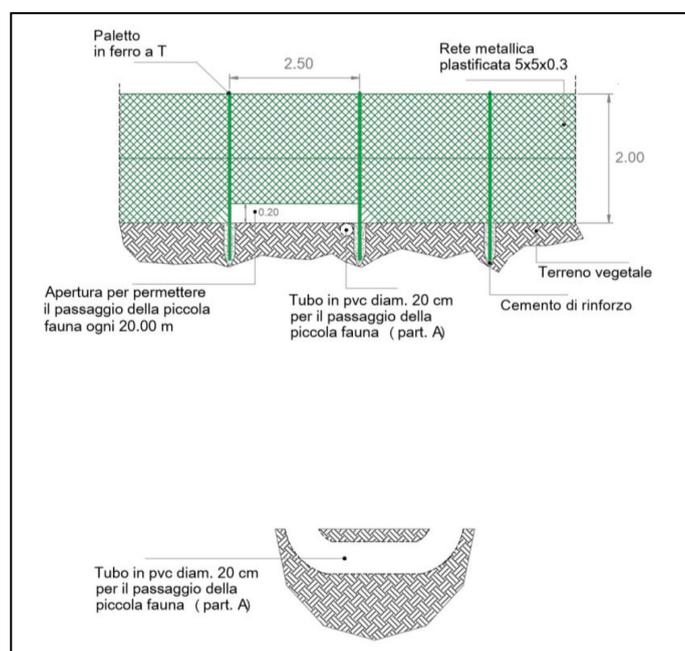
A - Dettaglio del passaggio della fauna lungo la recinzione perimetrale l'impianto
